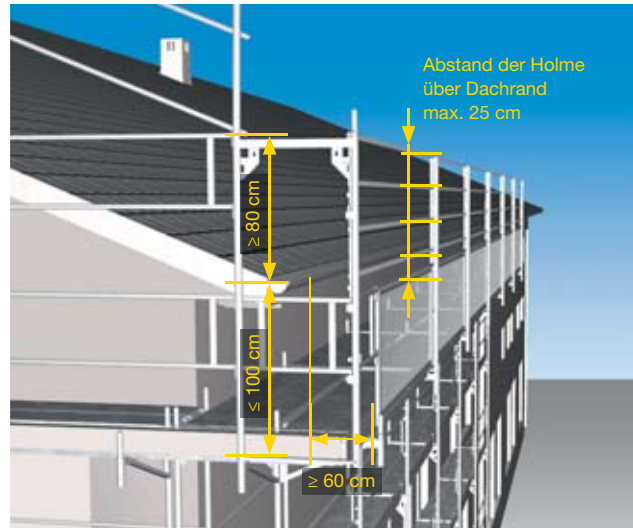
Spenglergang mit Dachdeckerschutzwand, Variante mit Holmen über dem Dachrand
